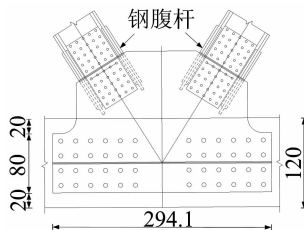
钢腹杆-混凝土板节点连接部分示意图(单位:cm)
